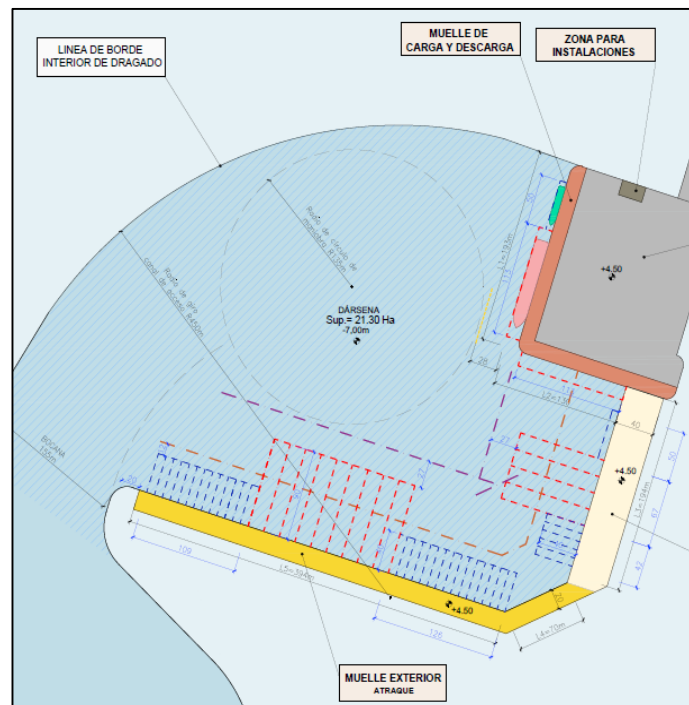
Plano Detalle Retroarea. (Ilustración obtenida del proyecto ejecutivo del módulo pesquero)
